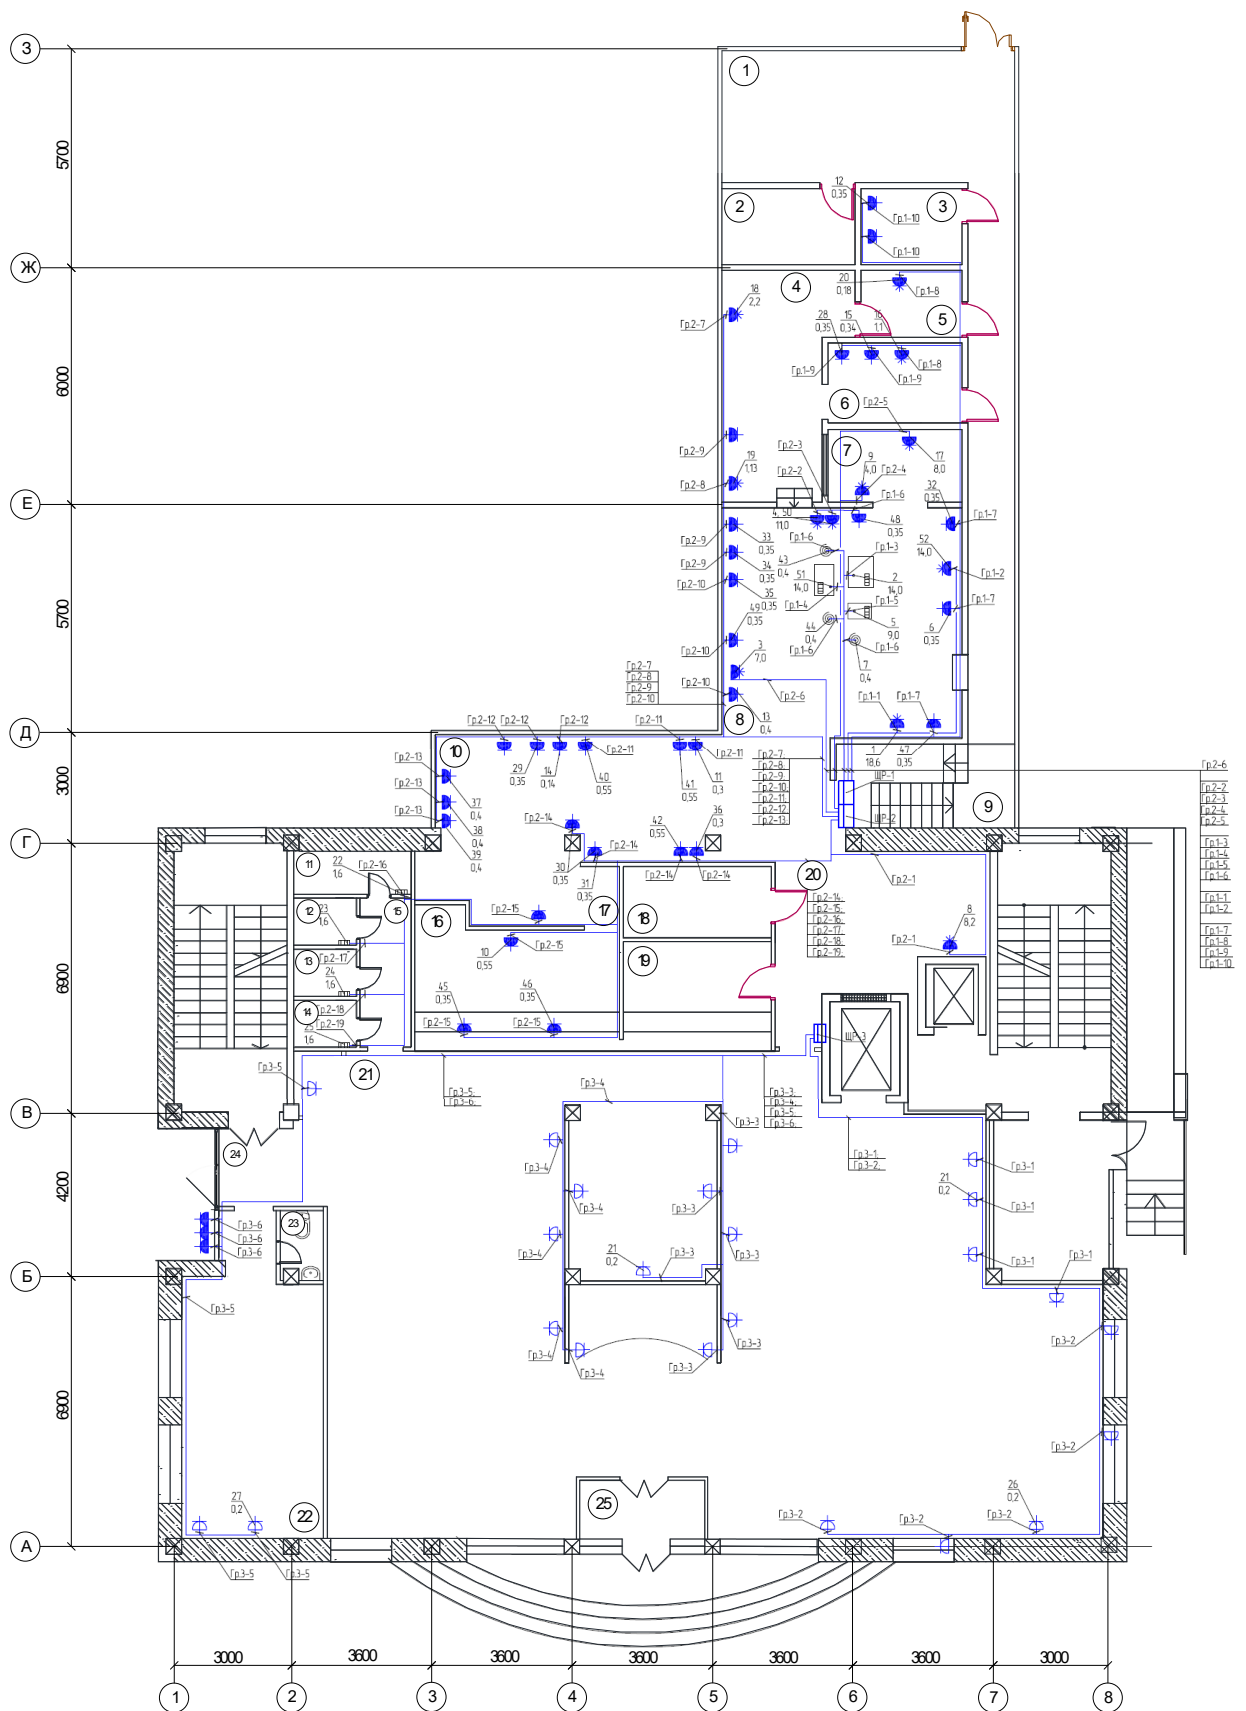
План силовой сети ресторана «Баран и бисер»,
